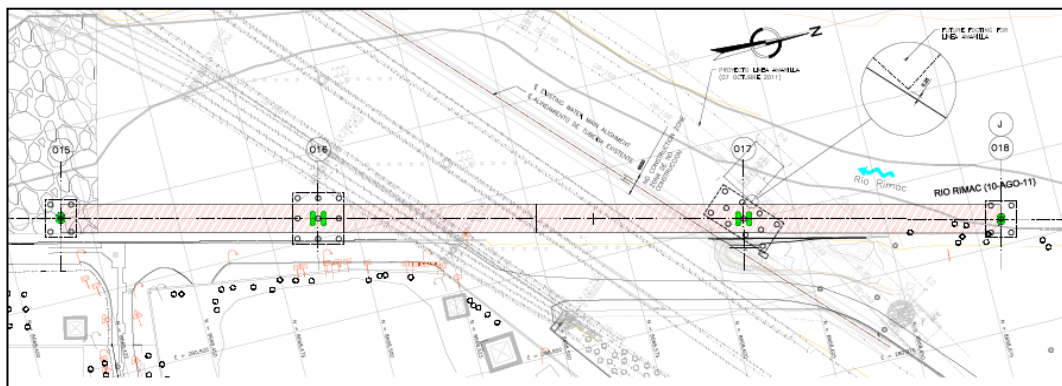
Planta Módulo MO5 (Punteo Evitamiento)
